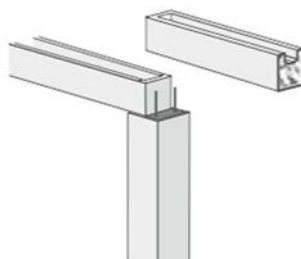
Ligação Viga-Pilar no topo dos pilares. Fonte: Cassol Pré-Fabricados
